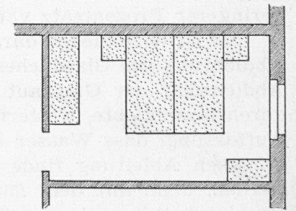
Das ist die Schlafzimmermöbelung, die die Architekten in diesem Falle in den Grundriss einzeichneten
